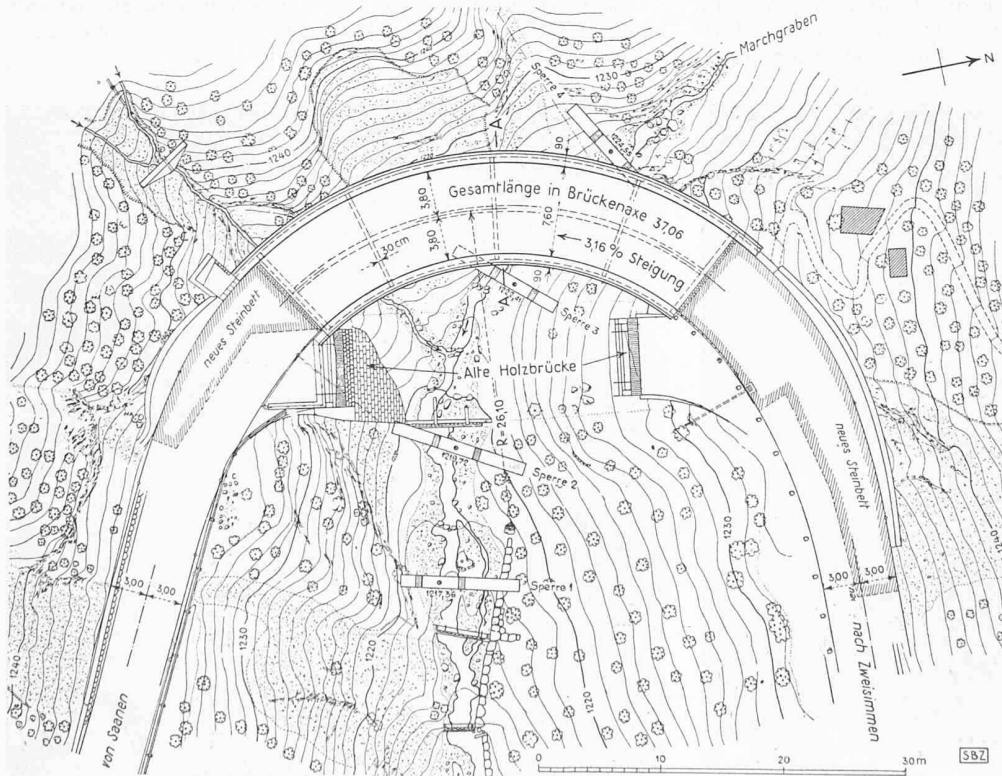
Marchgrabenbrücke, Lageplan und Grundriss 1 : 600
